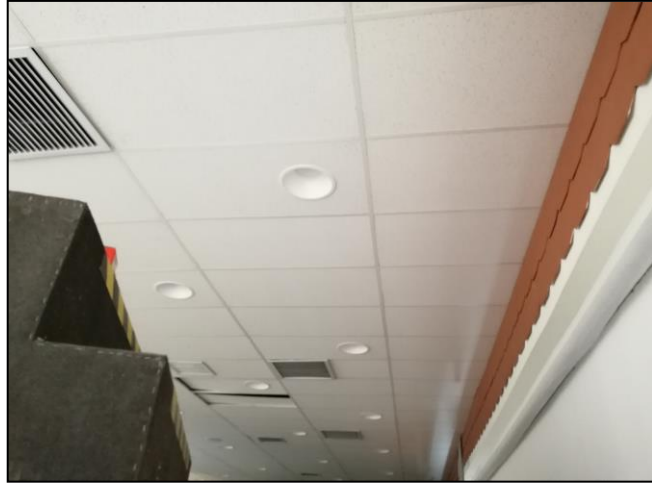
Instalación de bandeja y canalización en planta de techo.
